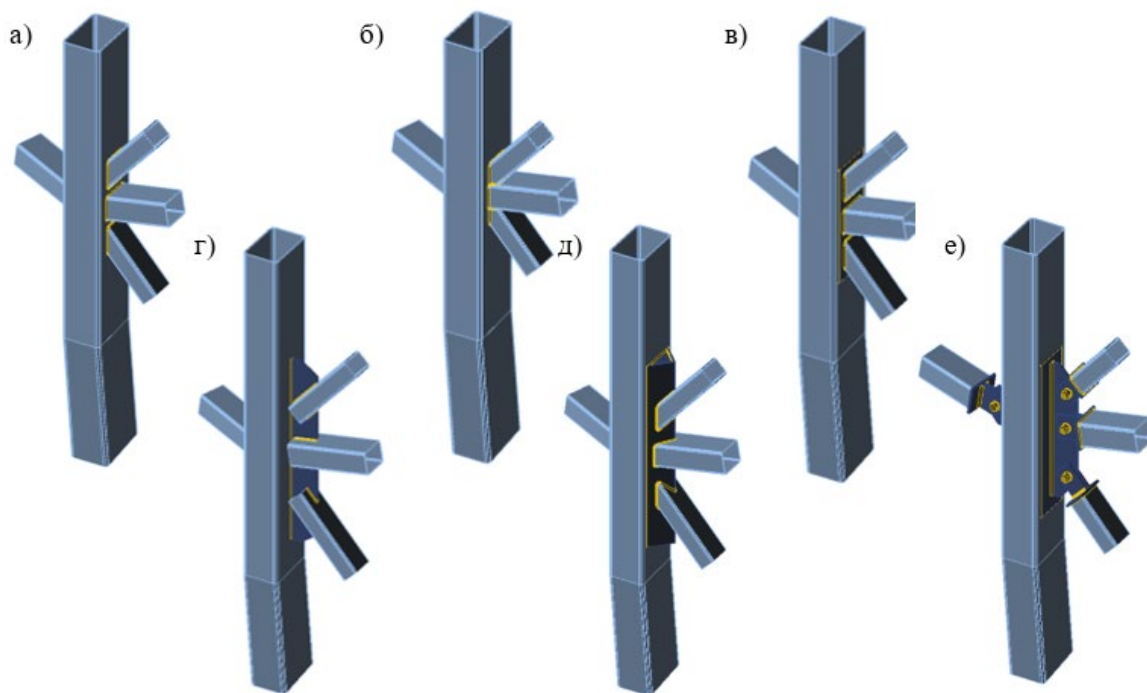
Варианты конструкций монтажного узла 1: а) первый вариант – исходный; б) второй вариант – трубы сдвинуты; в) третий вариант – трубы приварены через пластину усиления; г) четвертый вариант – трубы приварены к фасонке; д) пятый вариант – трубы приварены к прокатному равнополочному уголку; е) шестой вариант – болтовое соединение труб.
